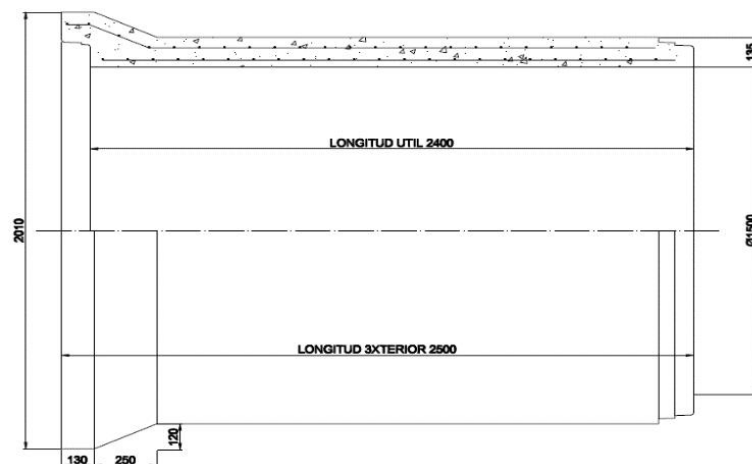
Dimensions de la peça exterior d'un tub prefabricat de formigó armat de diàmetre 1500 mm.
